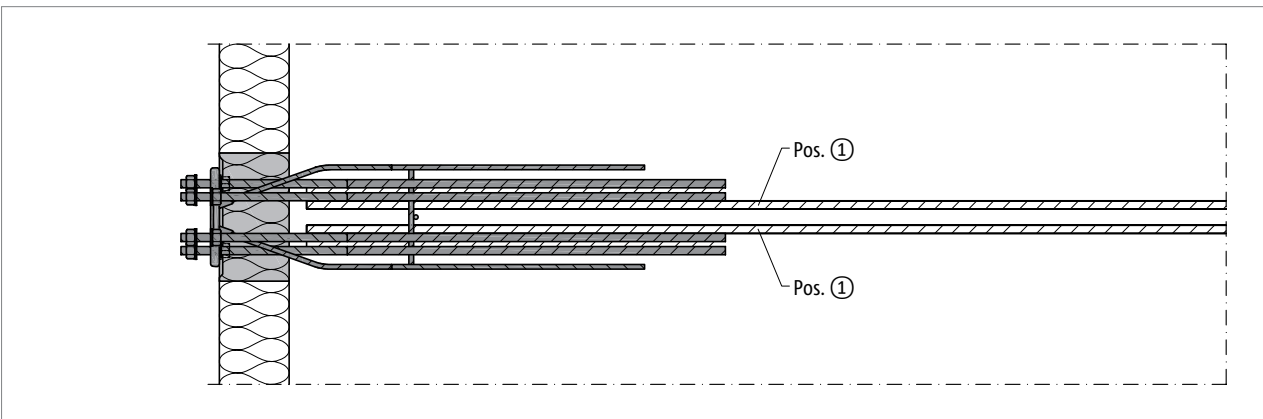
Schöck Isokorb® XT Typ SK-MM1-VV1: Bauseitige Bewehrung, Grundriss
